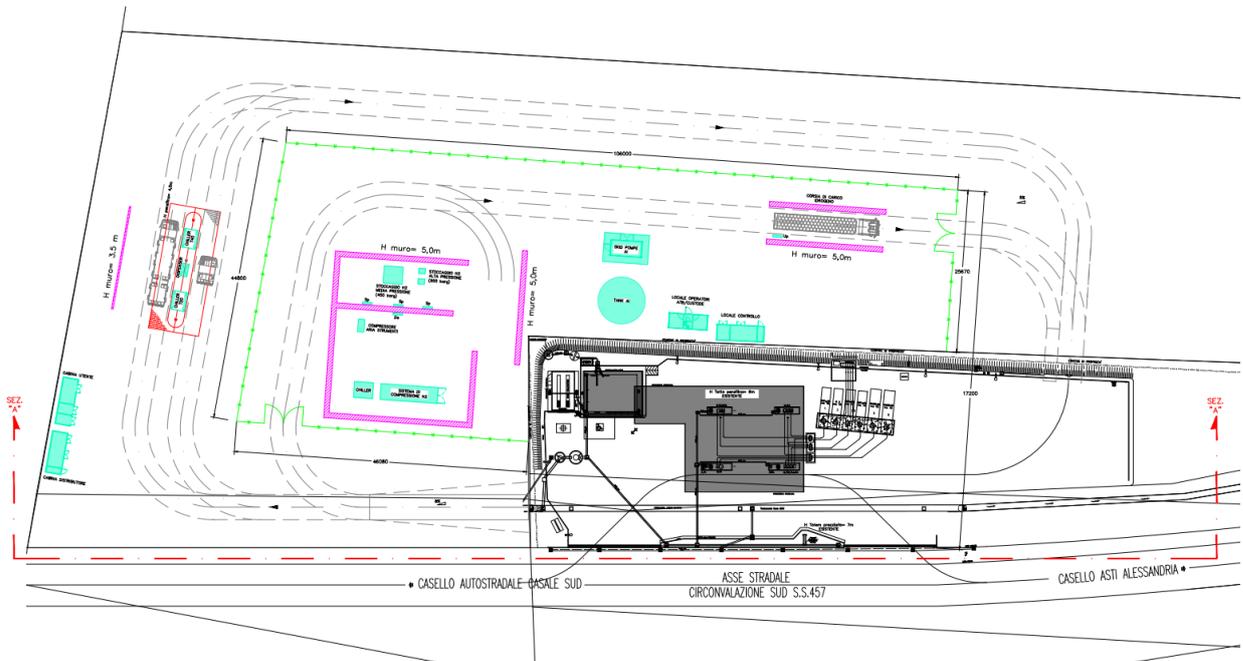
Planimetria HRS Casale Monferrato (turchese e rosa le nuove opere, in grigio la Stazione esistente)
